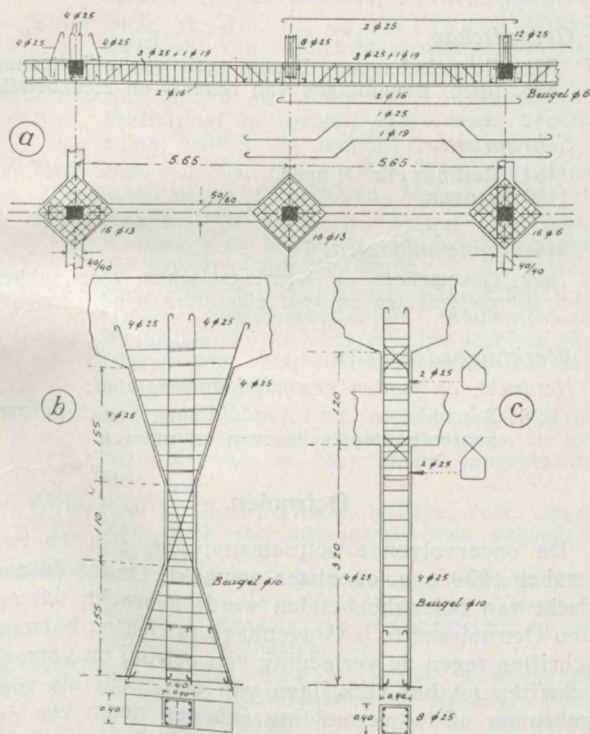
Gewapend beton winkelgebouw te San José, Costa Rica.
